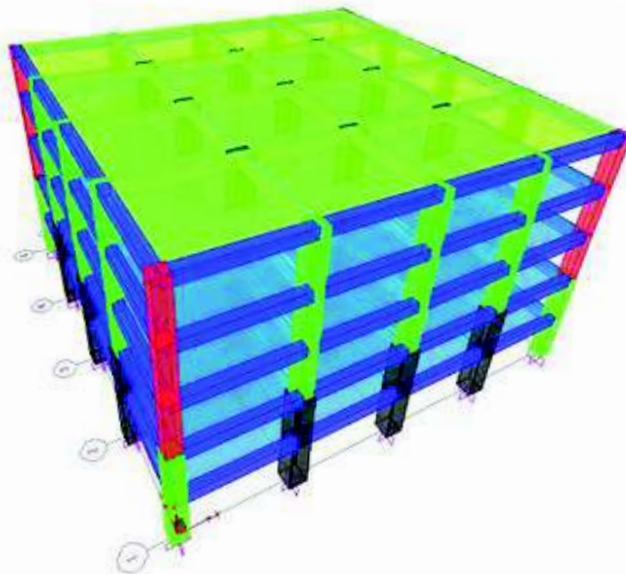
Edificio de 5 Pisos – Tridimensional
